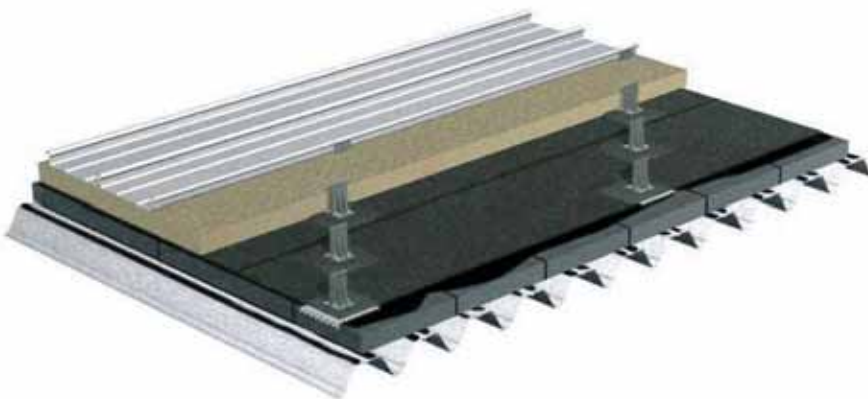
Кровельная конструкция без термических мостов с теплоизоляцией из пеностекла
